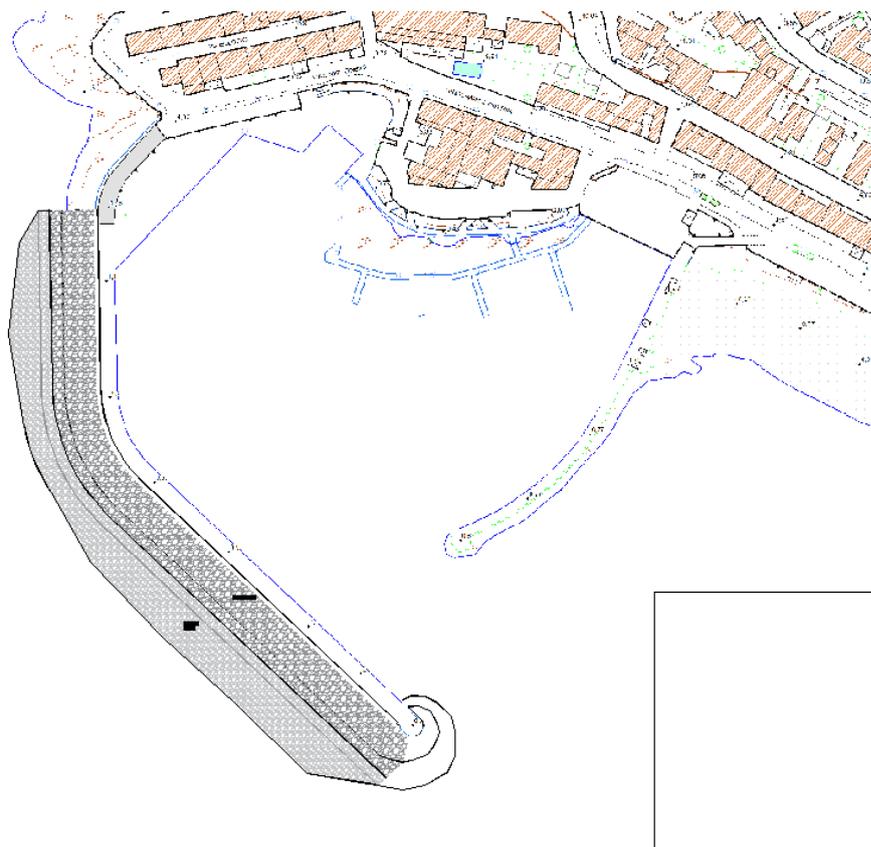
planimetria con indicazione sintetica degli interventi in progetto (vedi Tav. 5)
